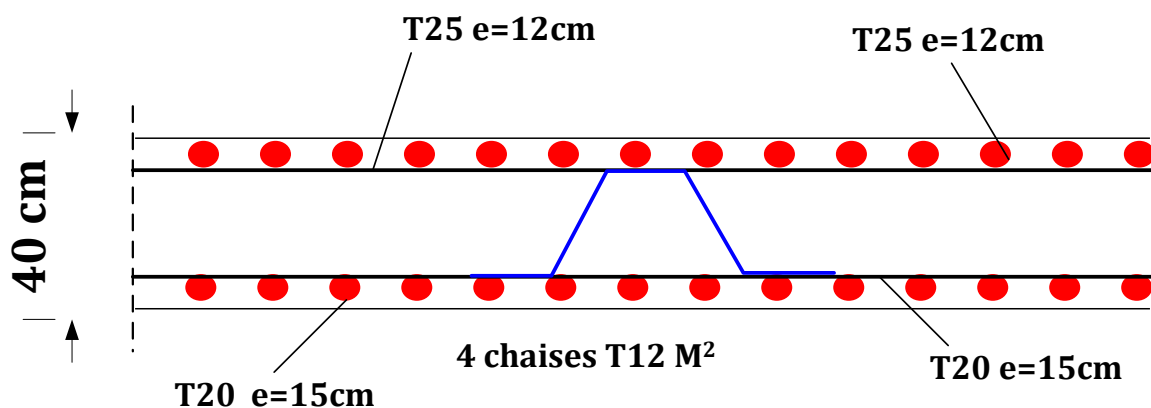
Schéma de ferrailage de la dalle de radier
